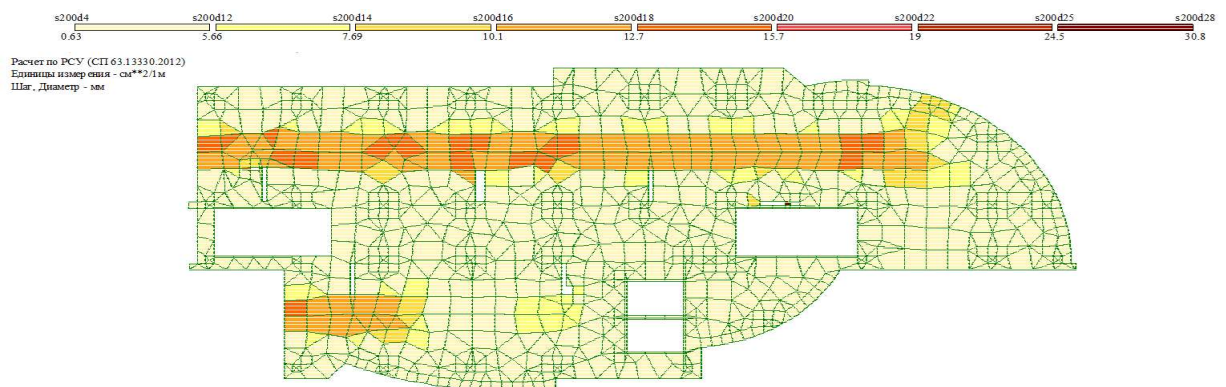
Нижнее армирование перекрытия этажа по оси У
